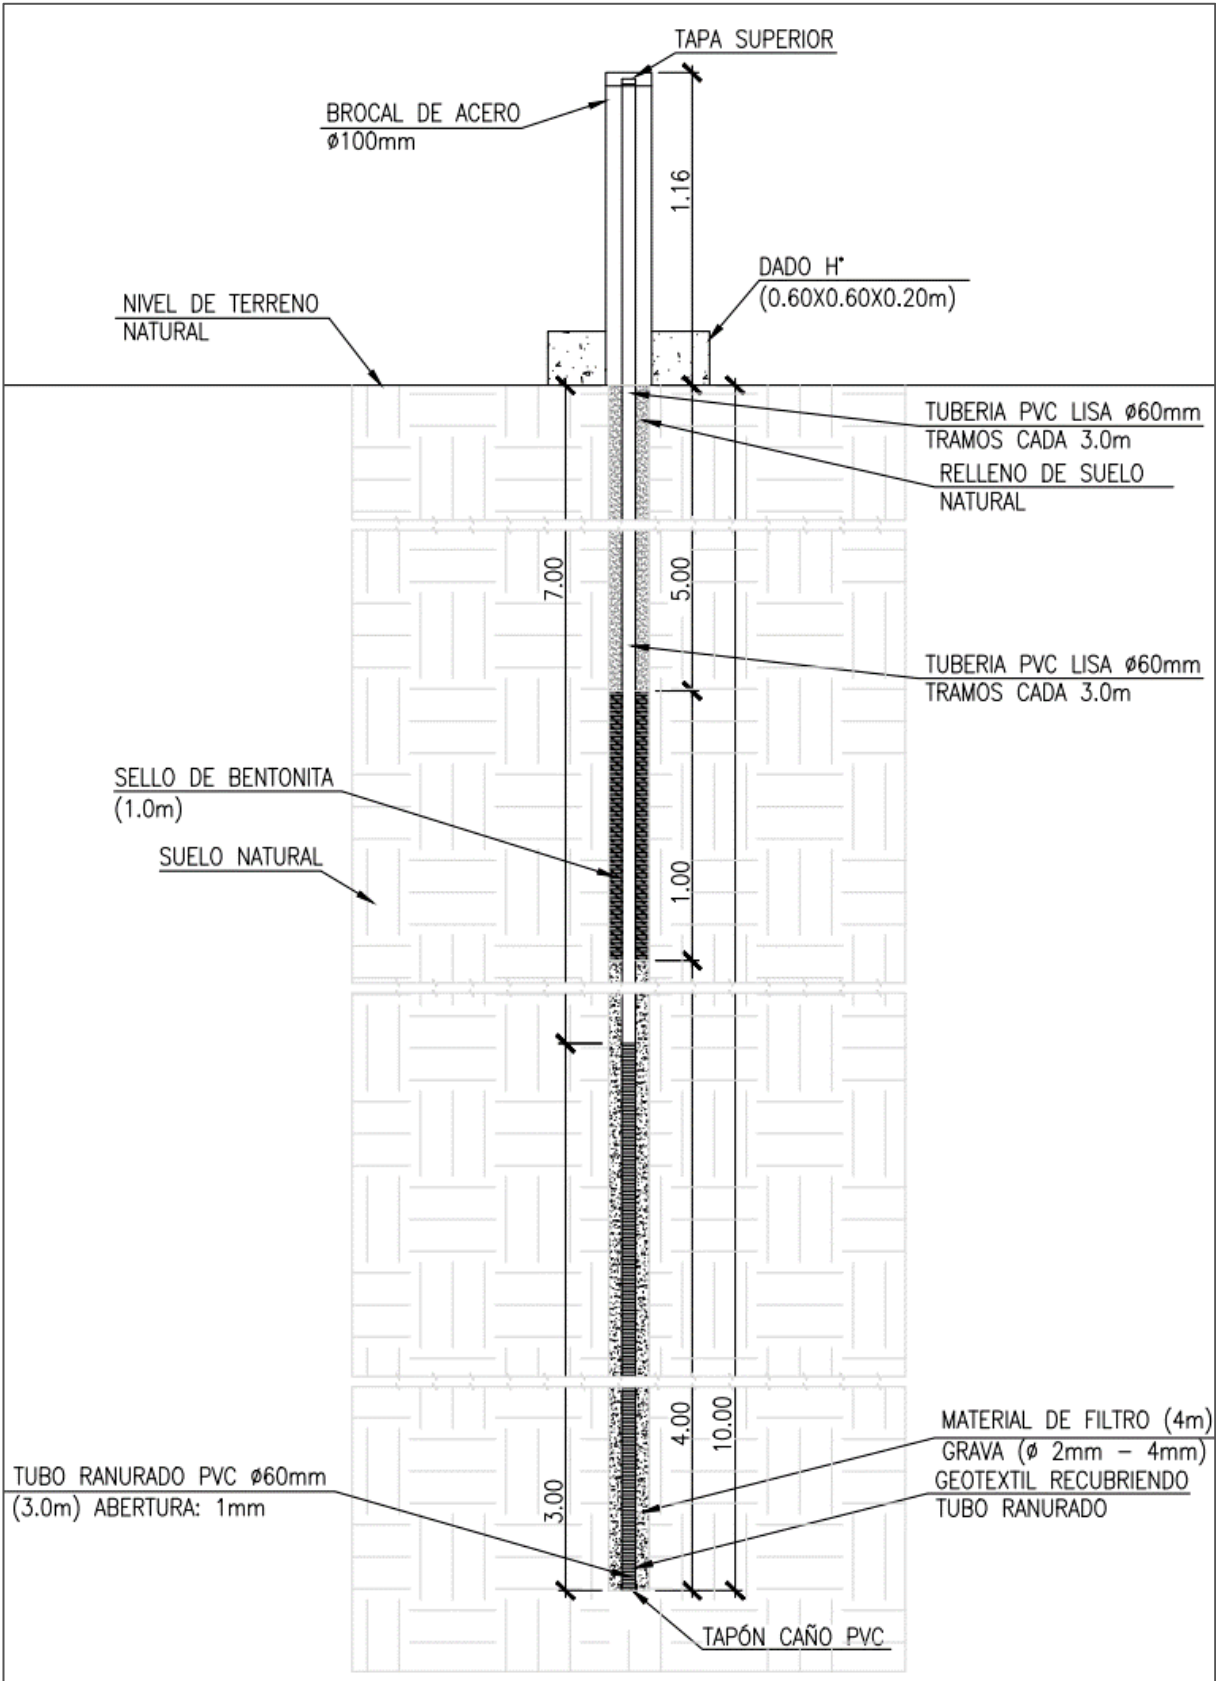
Esquema en detalle del perfil SRK-2023-BH08
